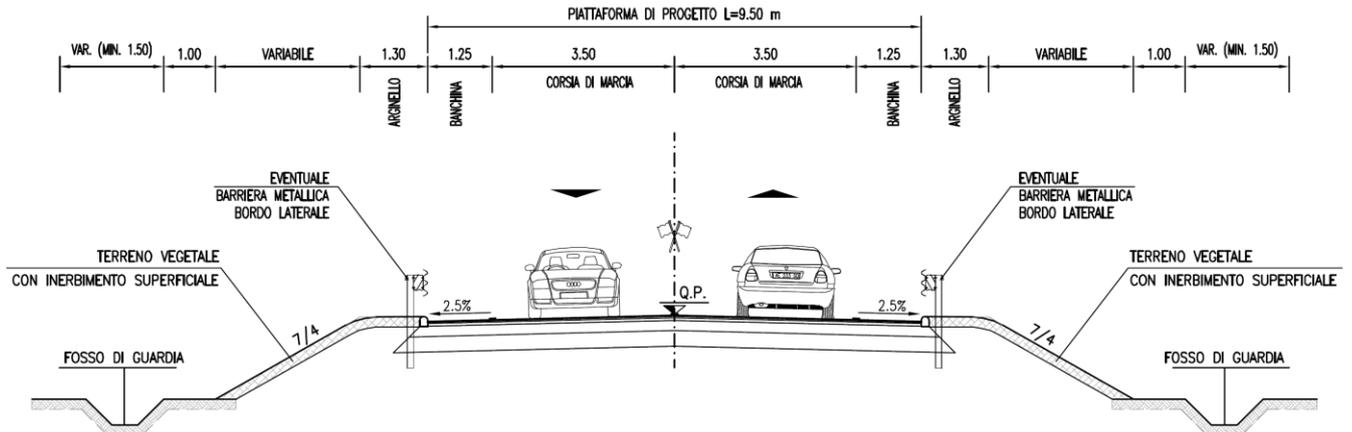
Sezione tipo in rilevato – Cat. C2 extraurbana secondaria
